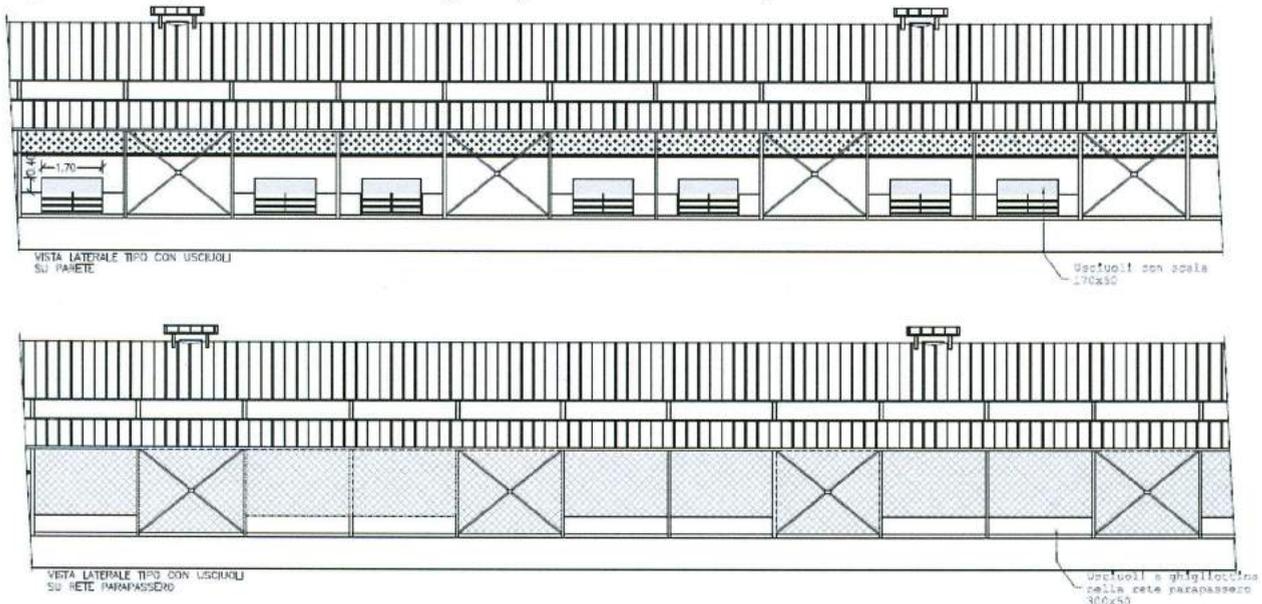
particolare del prospetto di un capannone dell'allevamento.
